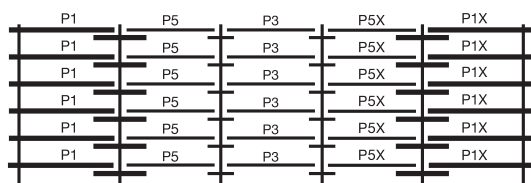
Szczegóły połączeń płatwi do konstrukcji głównej w systemie HEB
